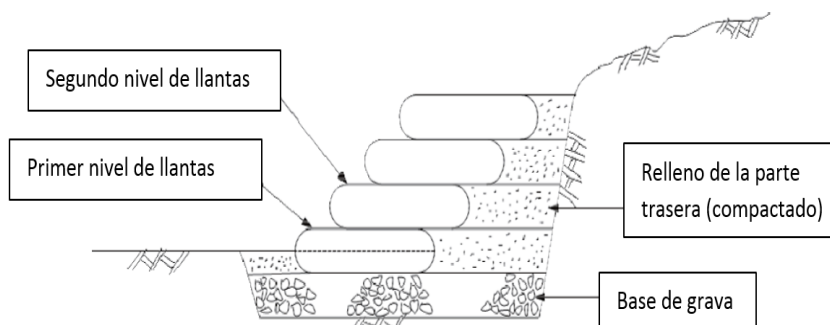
Estructura de apilamiento de llantas en un muro de contención. Vista frontal
